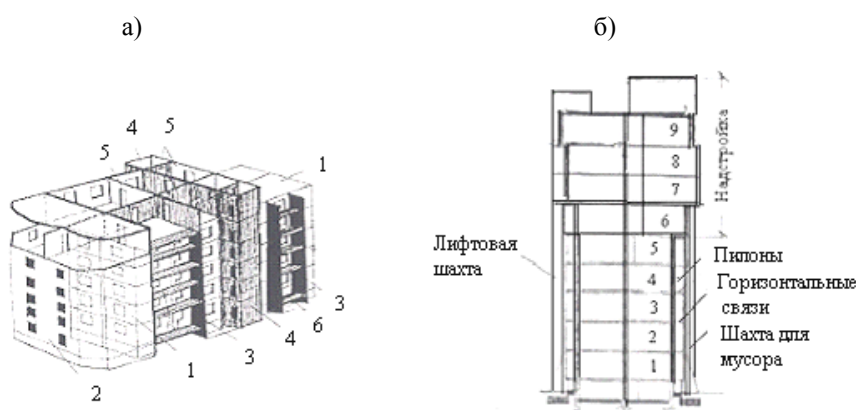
Объемная каркасная система с выносными монолитными рамными конструкциями
